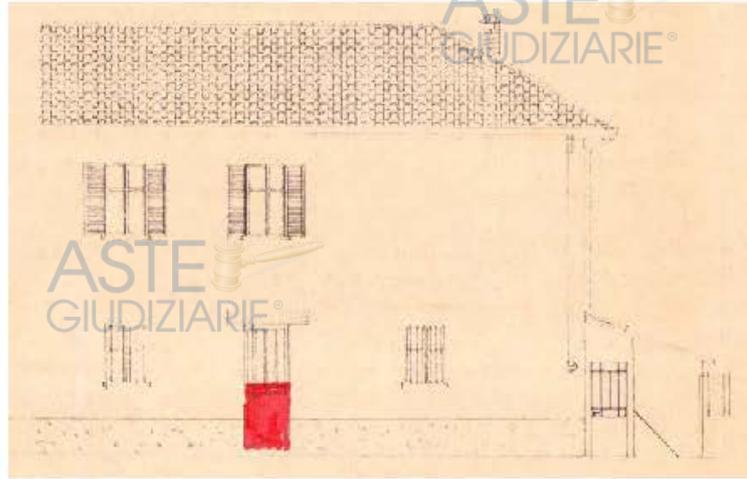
Estratto situazione autorizzata con Autorizzazione 79 del 23/01/1992 – prospetto su retro
